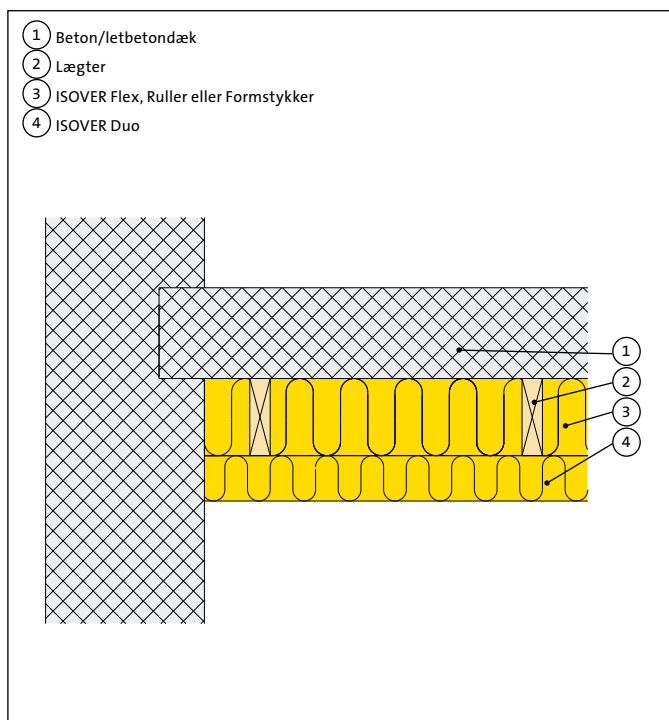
Opbygning af betondæk over kold kælder eller over det fri.
